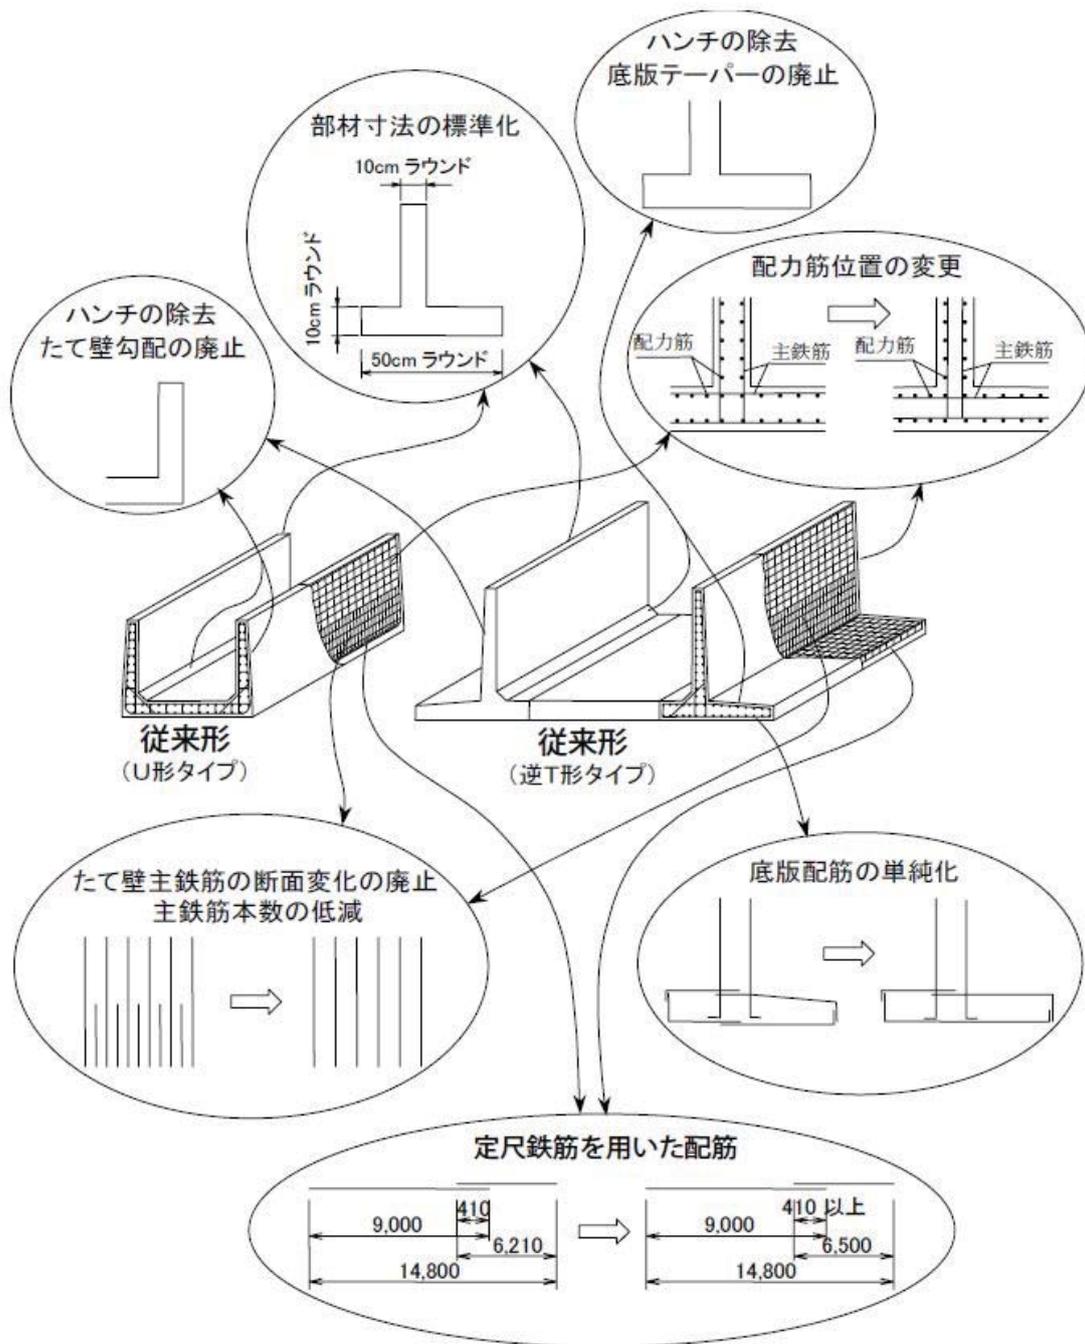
樋門の設計・施工合理化策の概要図 (翼壁)
